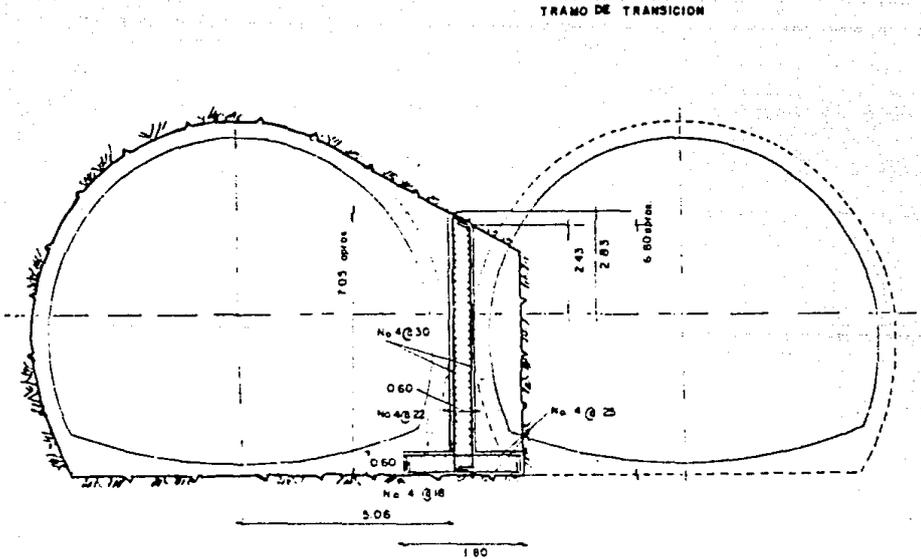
CONSTRUCCION DEL MURO CENTRAL
